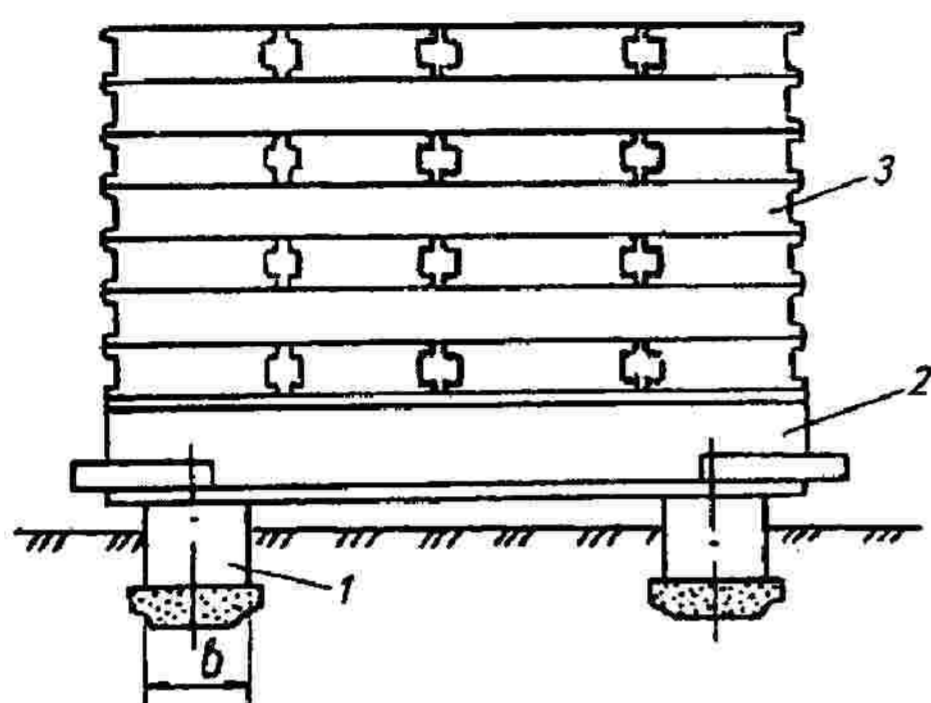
Схема установки из сборных блоков для испытания грунта в строительном котловане:
